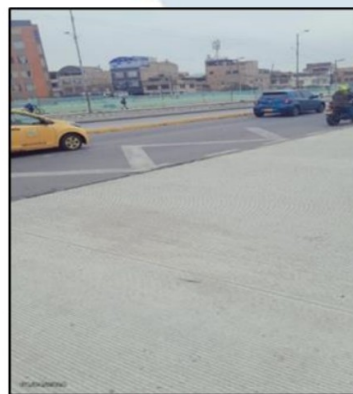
Bahía peatonal de paradero (piso duro) y demarcación vial de paradero
